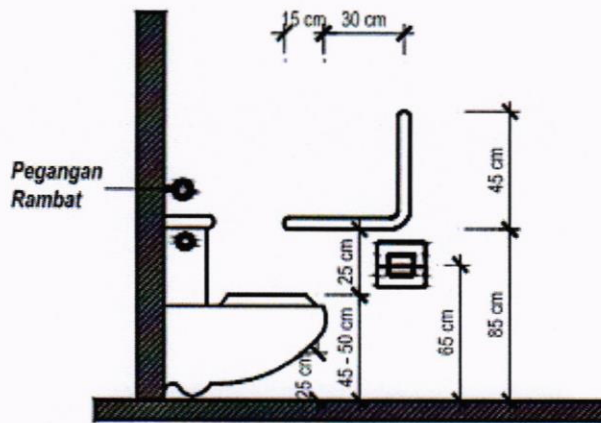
46 Analisa Ruang Gerak Pada Ruang Toilet (Pendekatan Diagonal) [2]
